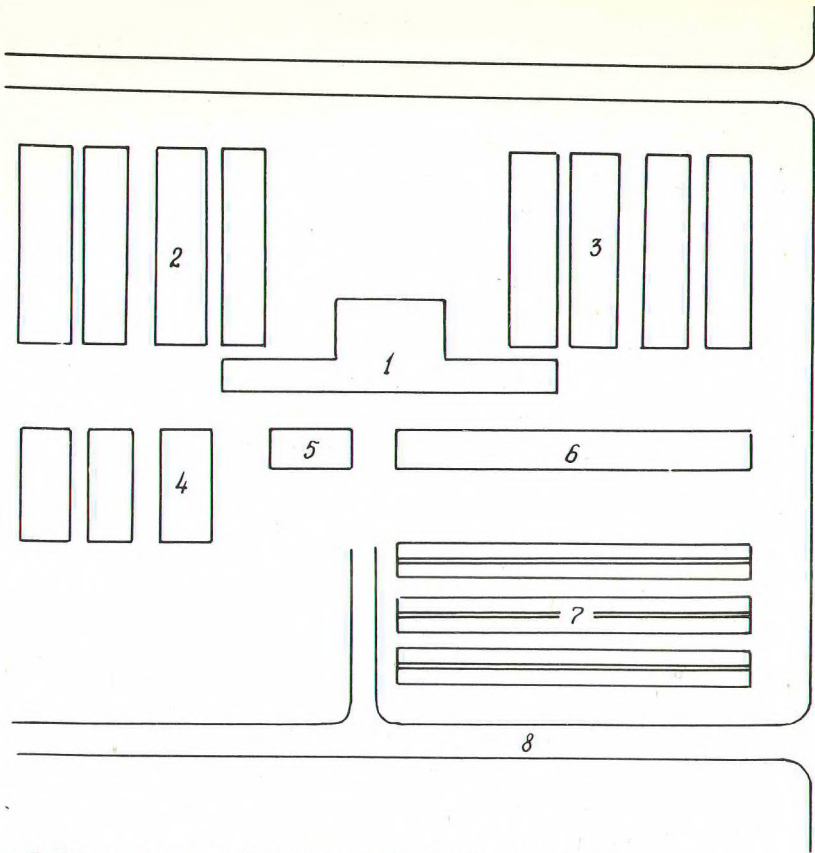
Схема строительной площадки для сборки лент колесопроводов:
